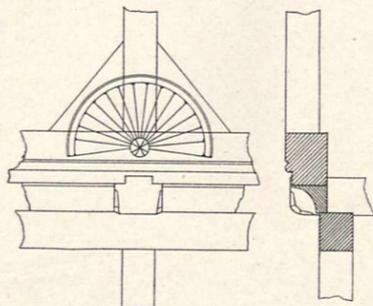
Fachwerk des Wohnhauses. 1:40.
